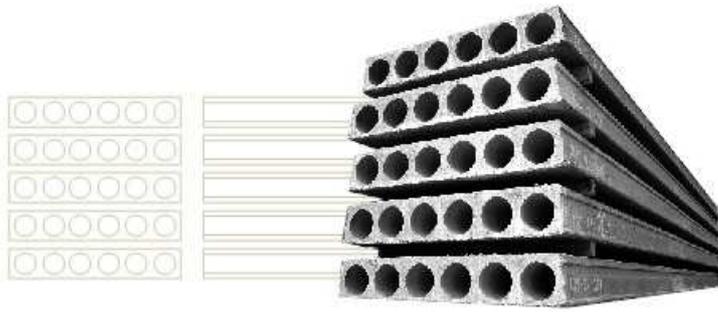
Laje alveolada (pretlanti - lajes e paineis alveolados).
